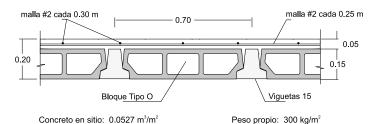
Detalle típico de entrepiso de vigueta de 15 cm con bloque tipo O
